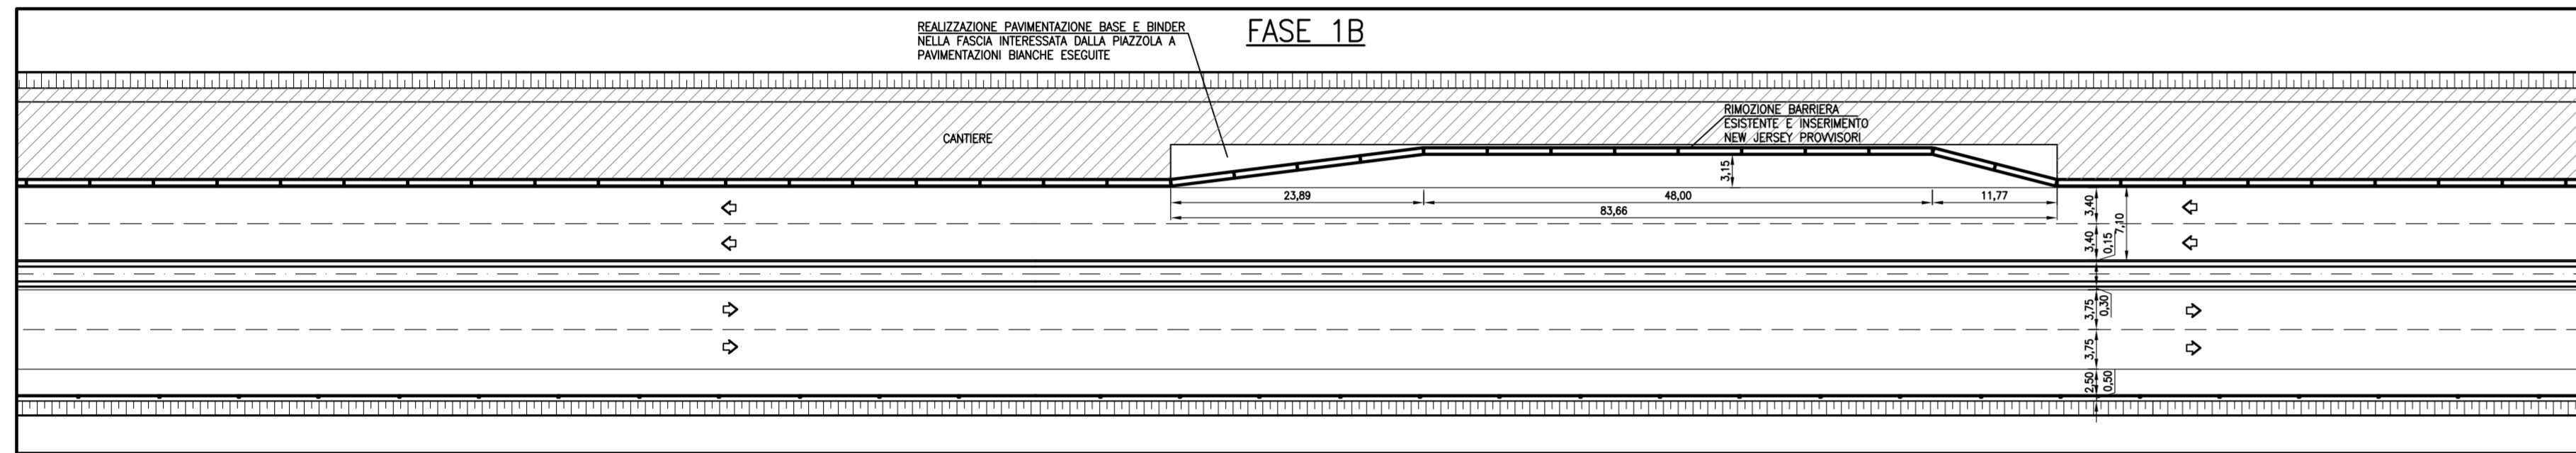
PIAZZOLA DI SOSTA LATO CANTIERE IN SECONDA FASE (DA PREVEDERSI OGNI 500 m)
